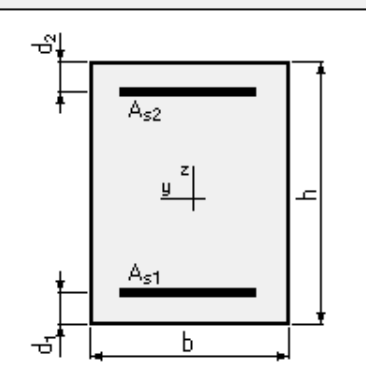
Capture d'écran sur sections d'armatures pour les Talons(Terrasse inaccessible) Y-Y
